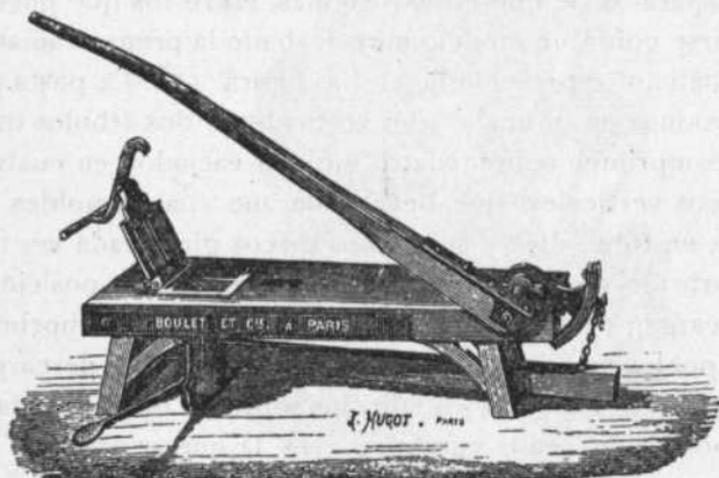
Prensa de Boulet para moldear ladrillos a brazo.
